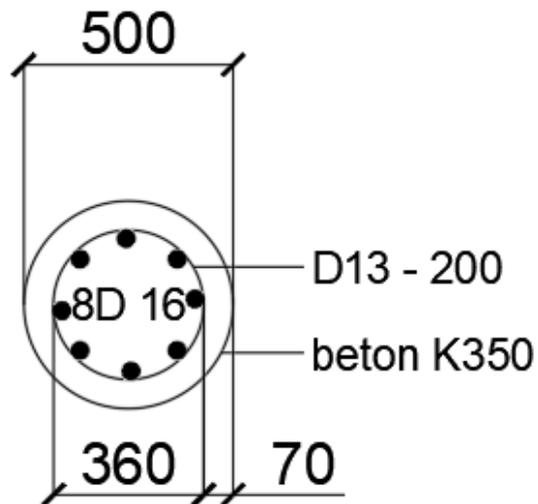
Denah Rencana Pondasi Bored Pile
